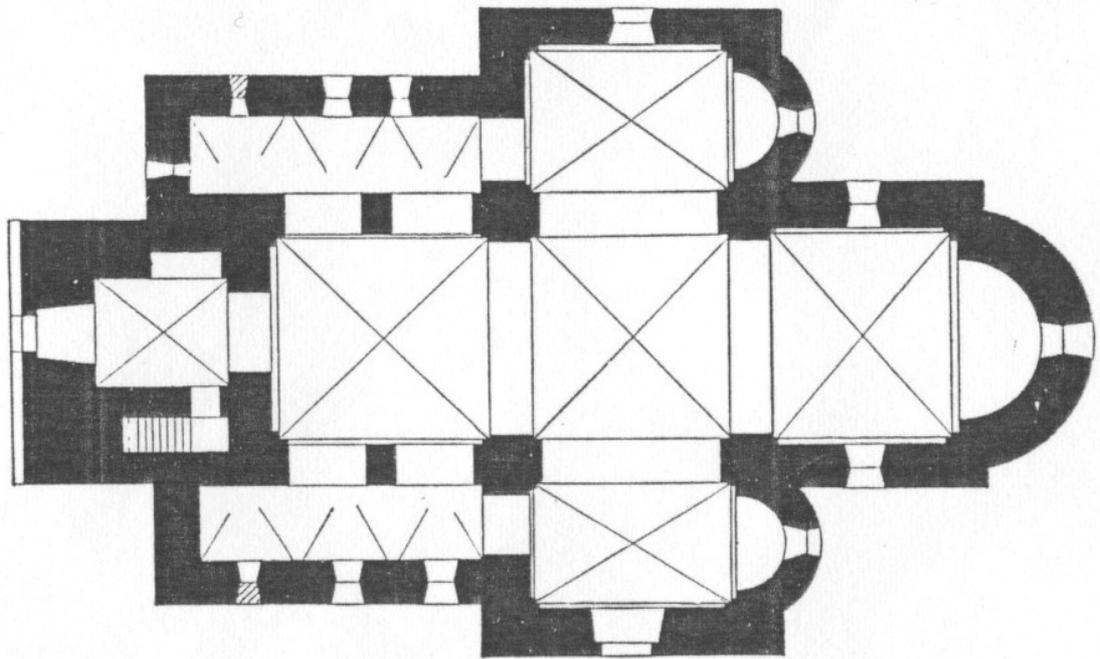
Grundriss der Kirche. Maßstab 1:400.
